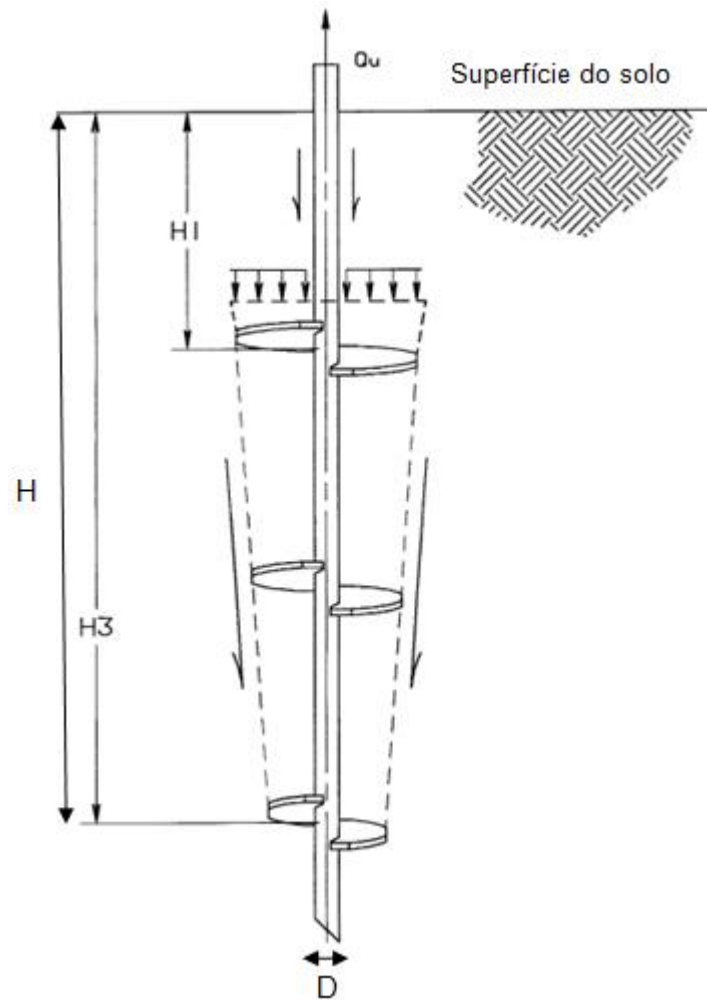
Superfície de rotura cilíndrica de estacas helicoidais
